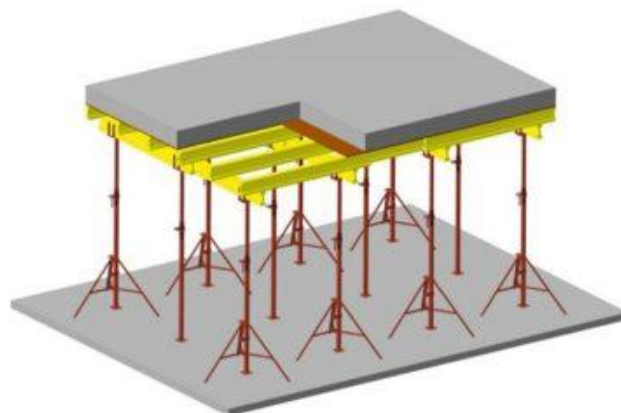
Формирование монолитного перекрытия с помощью системы телескопических стоек
